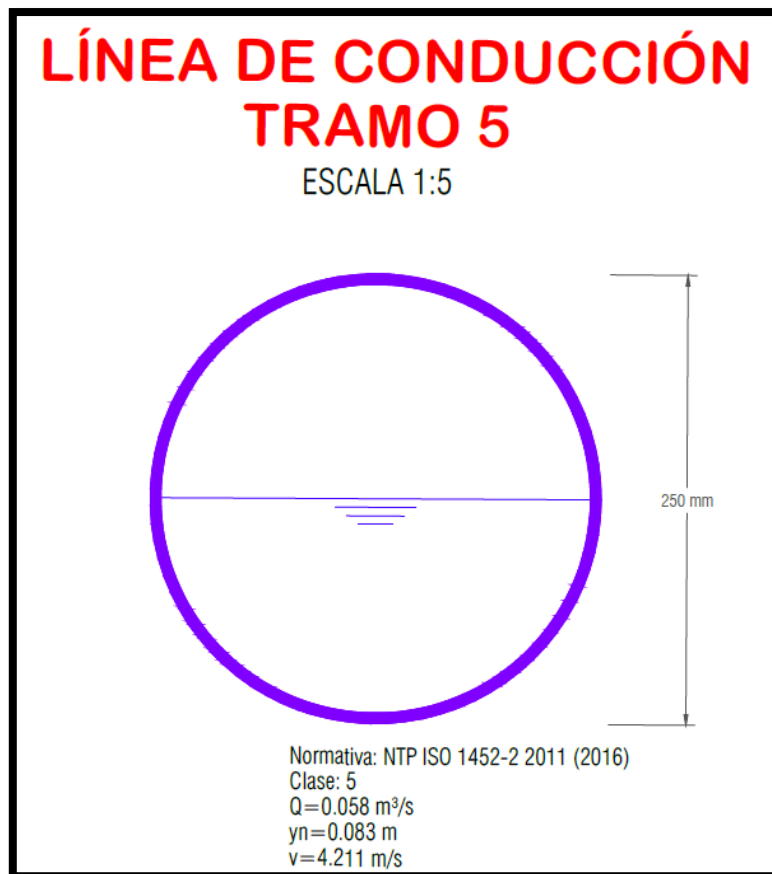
Sección típica de la tubería de PVC-U 250 mm, Tramo 5
